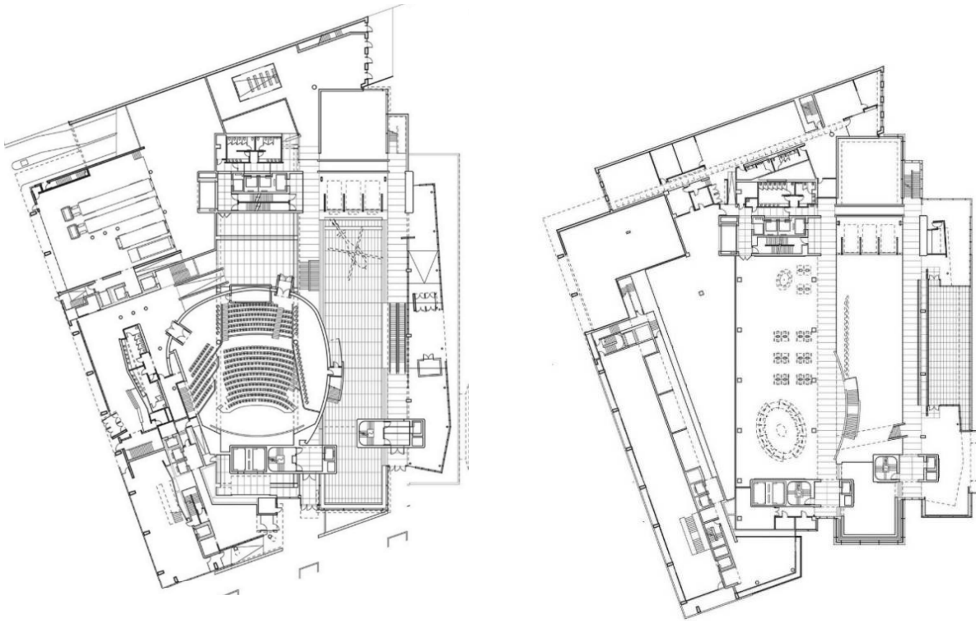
Planta alta y baja Newseum. Imagen obtenida en <https://raai.com/project/the-newseum/>
